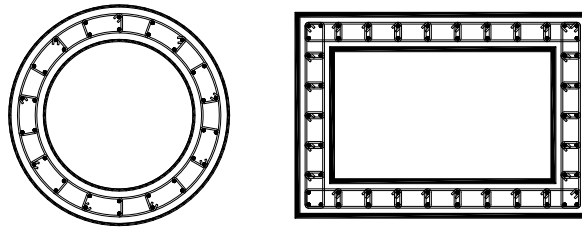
Pilas de muro rectangulares (Priestley et al., 1996).
